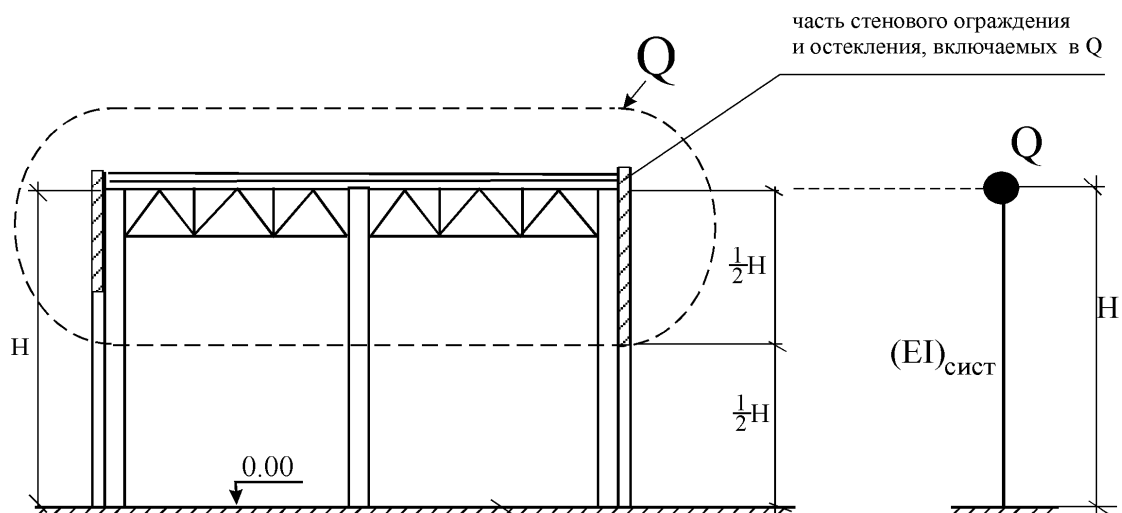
Формирование динамической расчетной схемы при жестком сопряжении стропильной конструкции с колоннами
